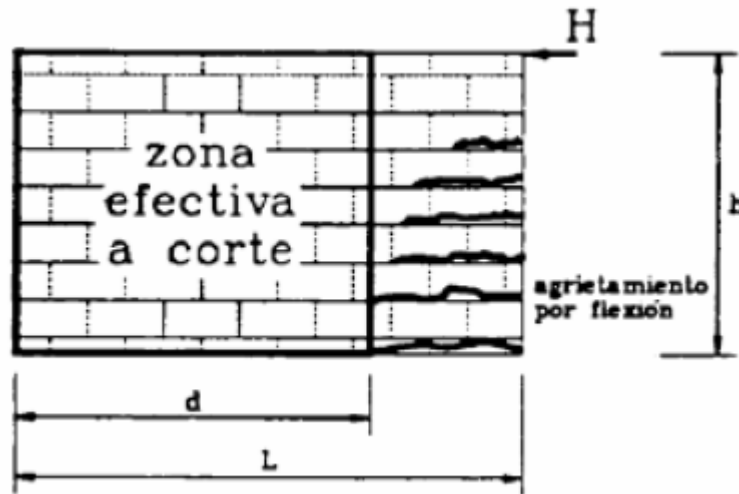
Zona efectiva a corte de muros de mampostería no reforzado. Fuente: (Gómez, Rodríguez, et al. 2006).
